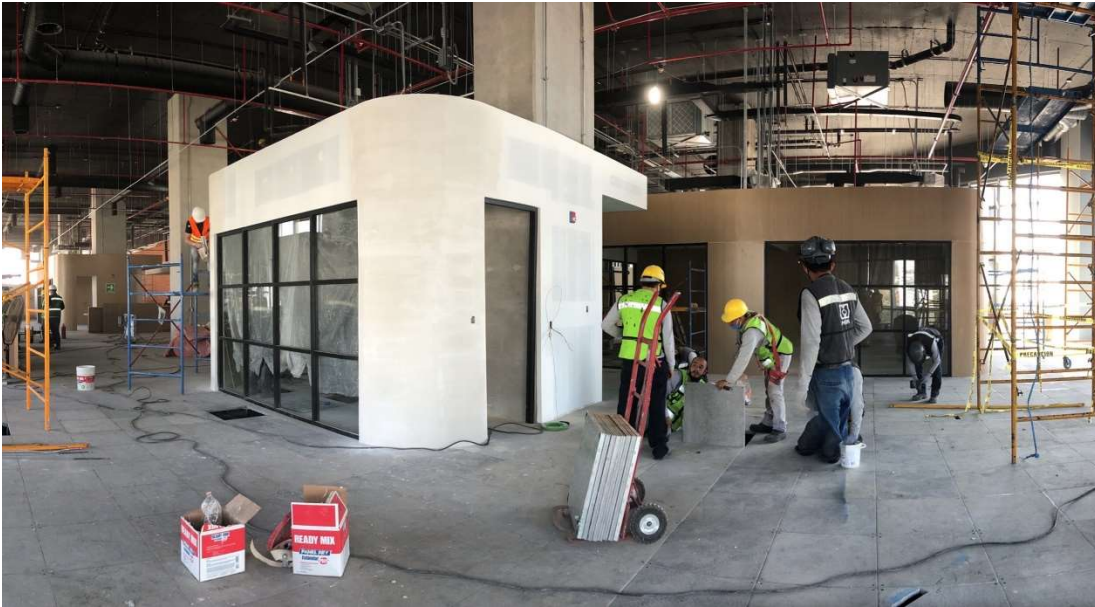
Semana 11: Continúan trabajos de pintura, laminado, cableados, montaje de equipos de aire acondicionado. (2020)
